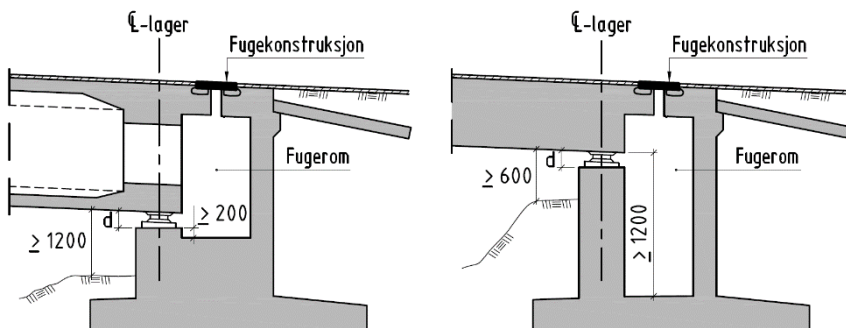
Eksempel på tilkomst til lager fra utsiden
